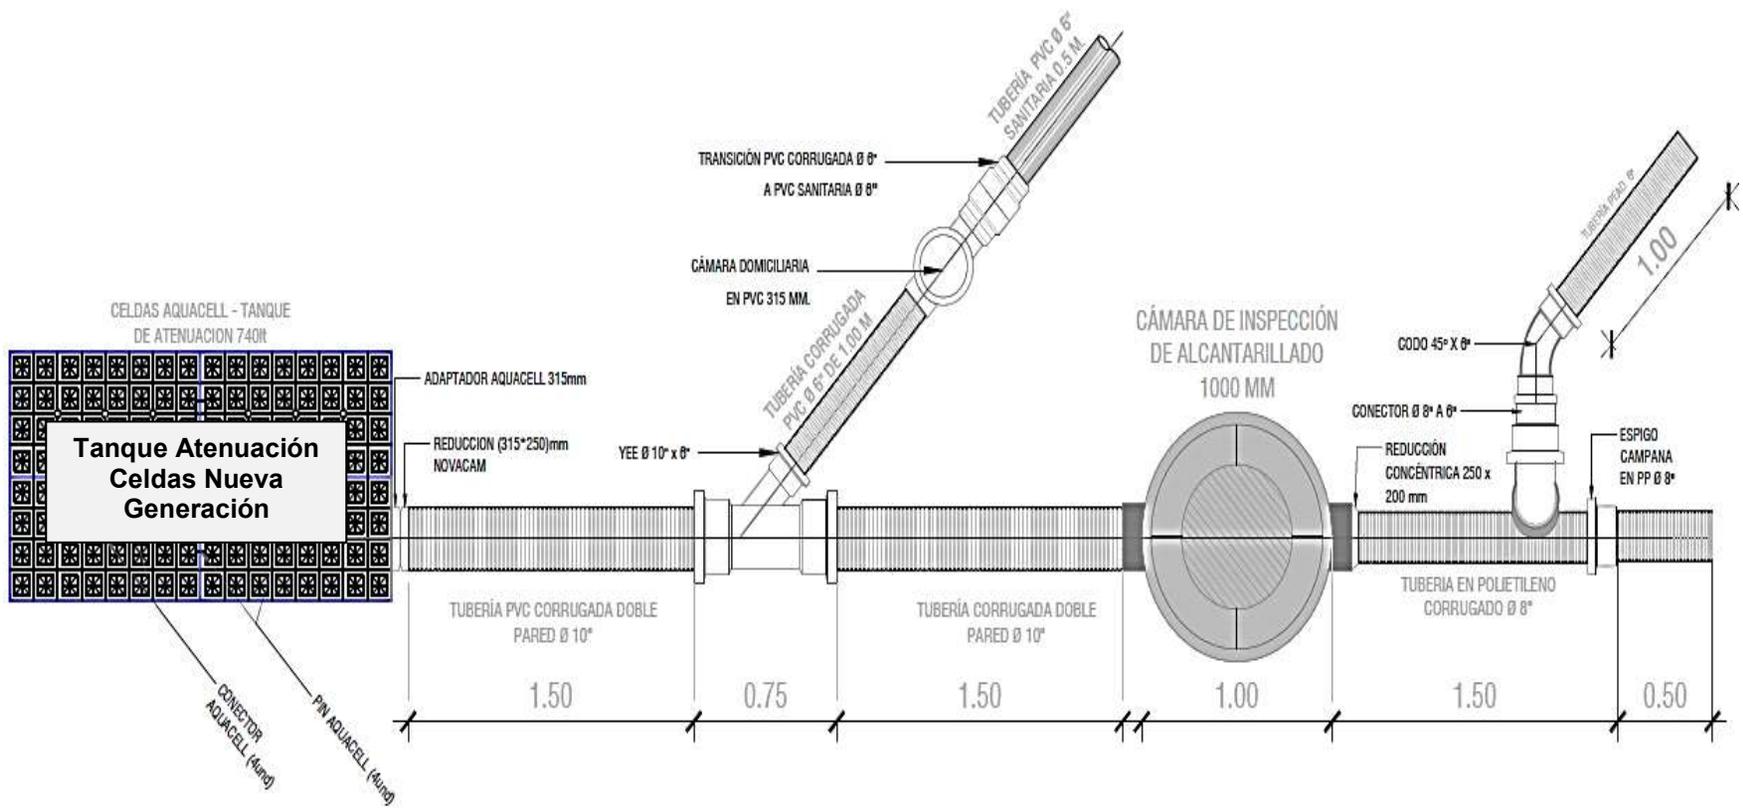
Prueba 4 - Montaje de alcantarillado Pluvial en tuberías plásticas.
